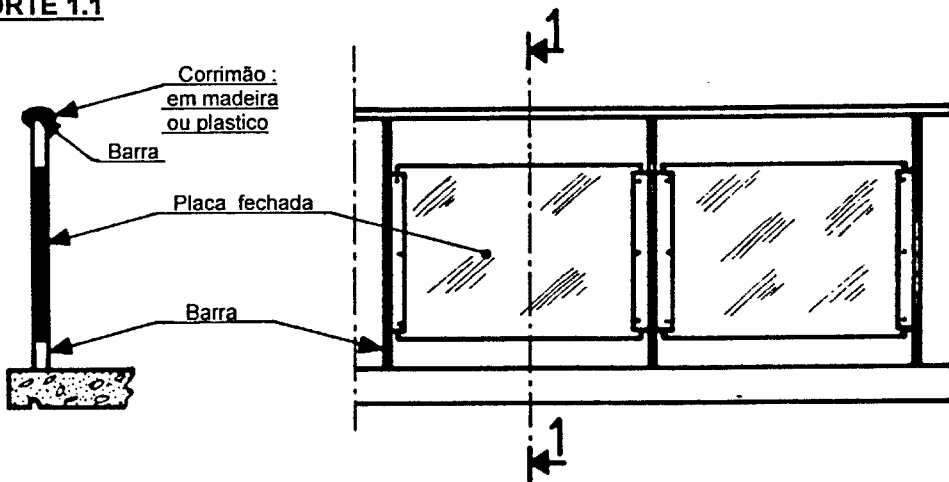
GUARDA-CORPOS COM PLACA FECHADA
